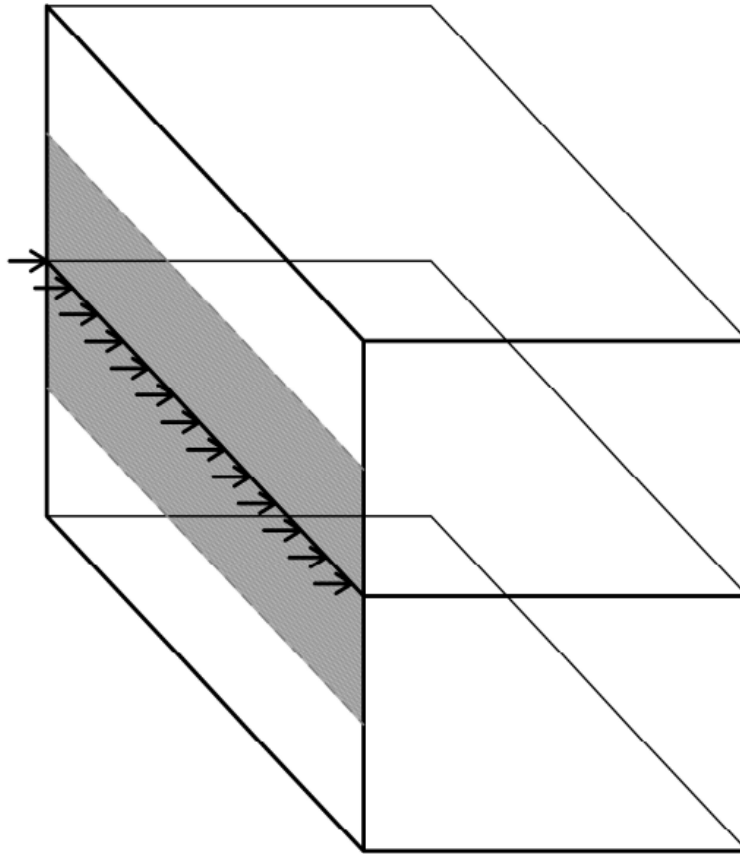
Ilustración de aplicación de las cargas de viento sobre el modelo estructural
